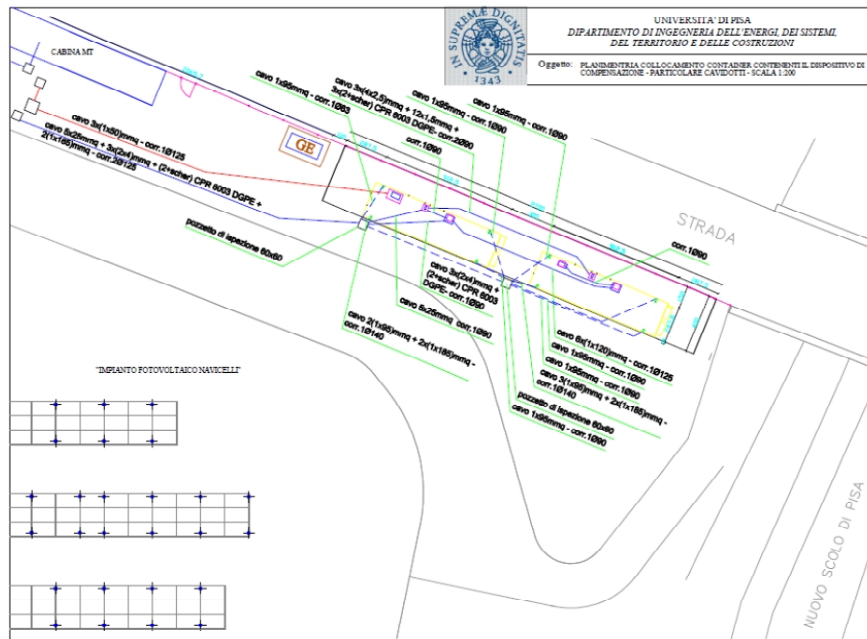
Planimetria disposizione sistema di compensazione: particolare cavidotti
